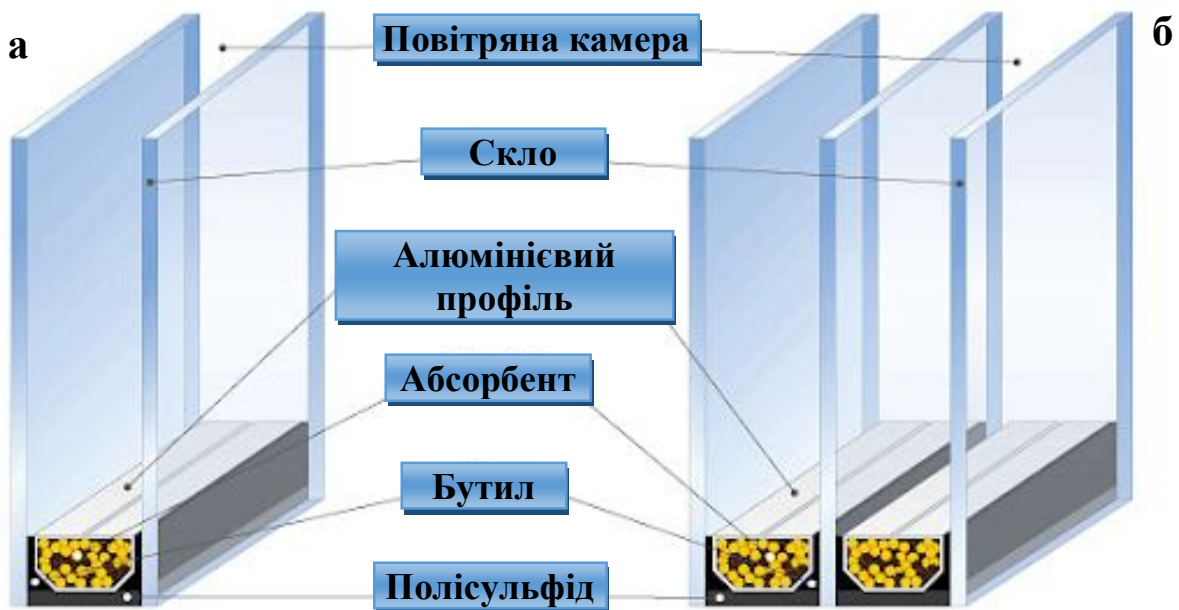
Конструкція склопакетів: а – однокамерний; б – двокамерний
